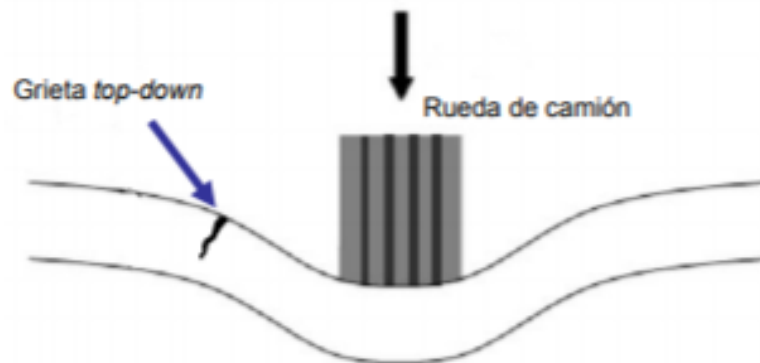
Desarrollo de fisura Top-Down en pavimento con asfalto envejecido. Tomado de “Sobre las enfermedades de los pavimentos de las carreteras” por Del Val Melús & Medina, 2010, Madrid, España: Universidad Politécnica de Madrid
